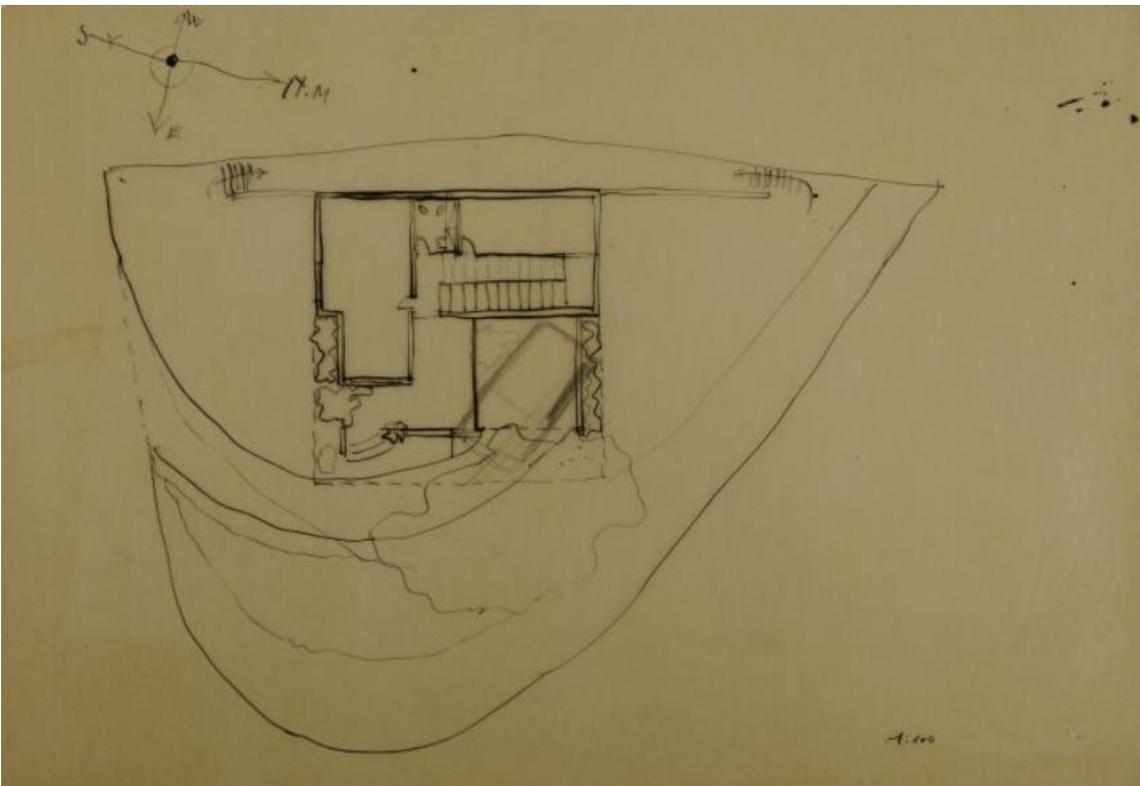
planta de la Casa do Chame-Chame, 1958, archivo Instituto Bardi
